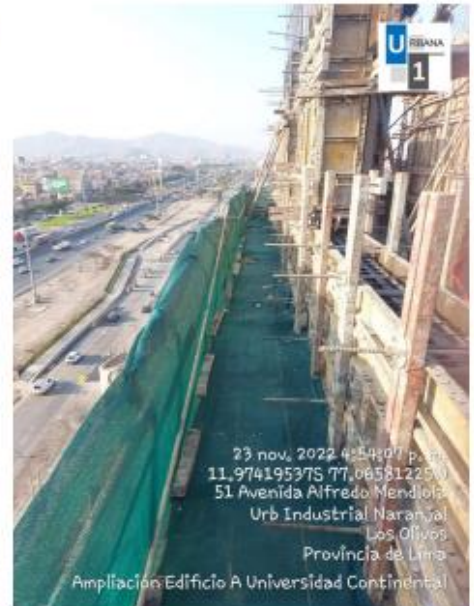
y N°16: Colocación de plástico blanco en barandas y colocación de barandas y malla raschell en exterior de fachada.
